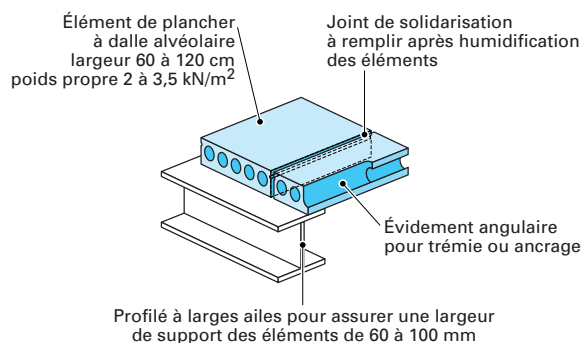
Plancher à poutrelles métalliques et dalle alvéolaire
